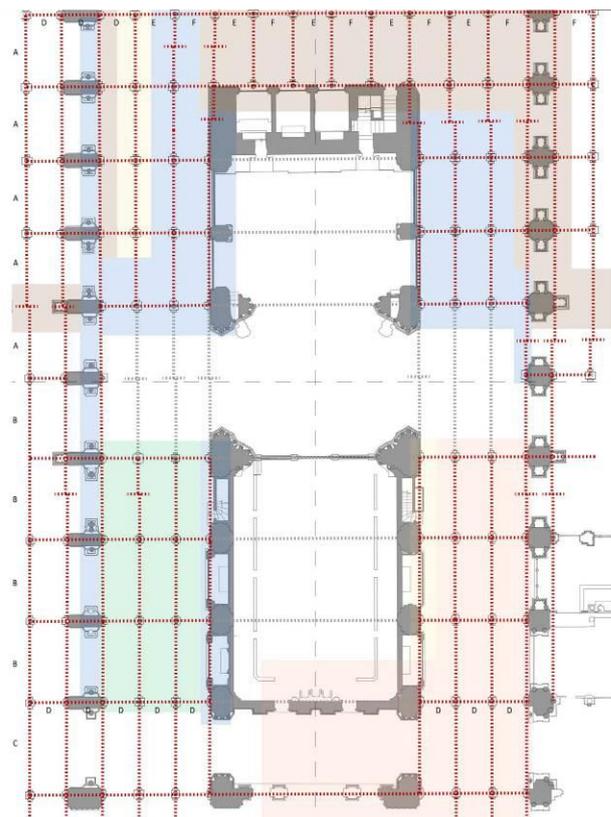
Análisis de la traza sobre planta de la Mezquita de G. Ruiz Cabrero (2009).
